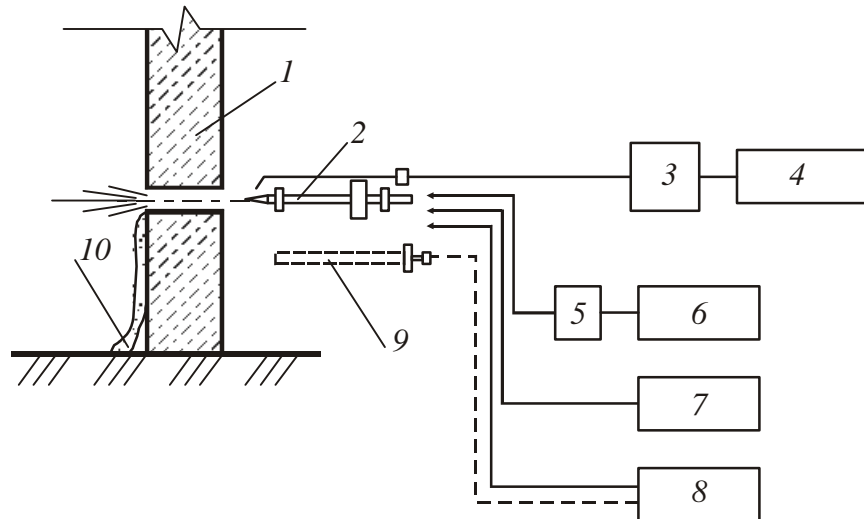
Прорезание горизонтальной стены с помощью порошкового резака: 1 – стена; 2 – порошковый резак; 3 – распределитель порошка; 4 – компрессор; 5 – регулятор; 6 – ацетилен; 7 – греющий кислород; 8 – режущий кислород; 9 – трубка с сердечником; 10 – шлак
